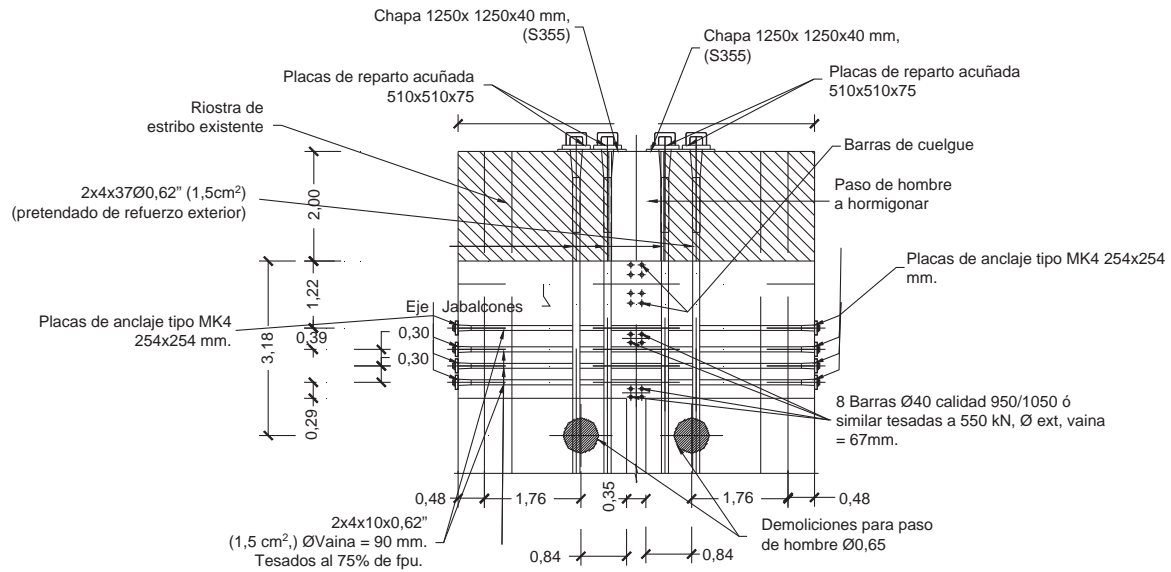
Sección en planta de la riostra de anclaje del pretensado exterior situado en el interior de cajón, en el estribo del lado Asturias.
